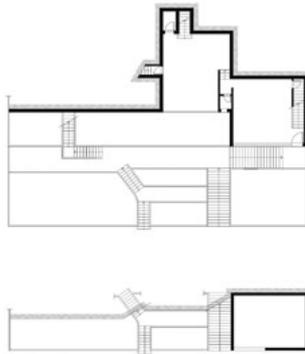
Abaixo, planta do nível Garagem e acima, planta do nível Vestíbulo e Recreio.
